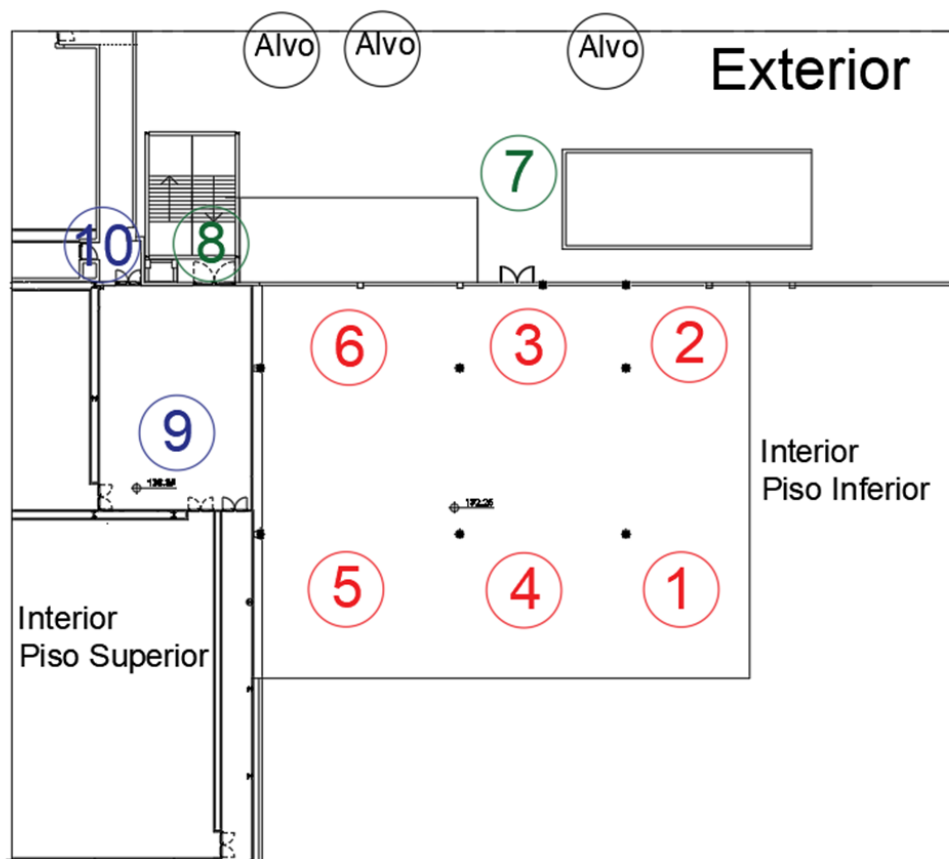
Planta com localização de estacionamentos do equipamento e alvos
